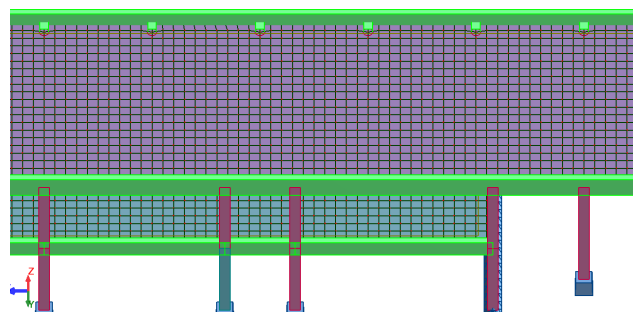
Modelação de consolas curtas e ligação viga-pilar
